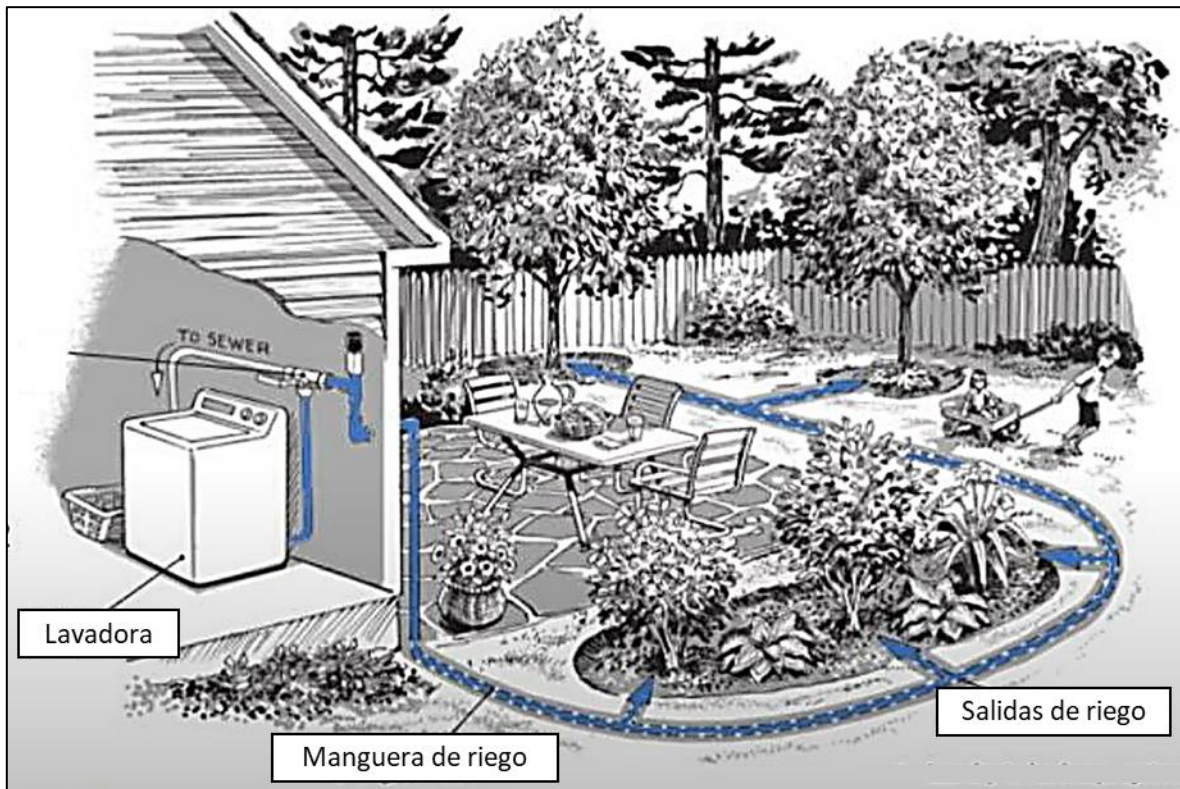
Esquema simplificado sistema “Laundry to Landscape” (adaptado de Greywater Action, 2016).
